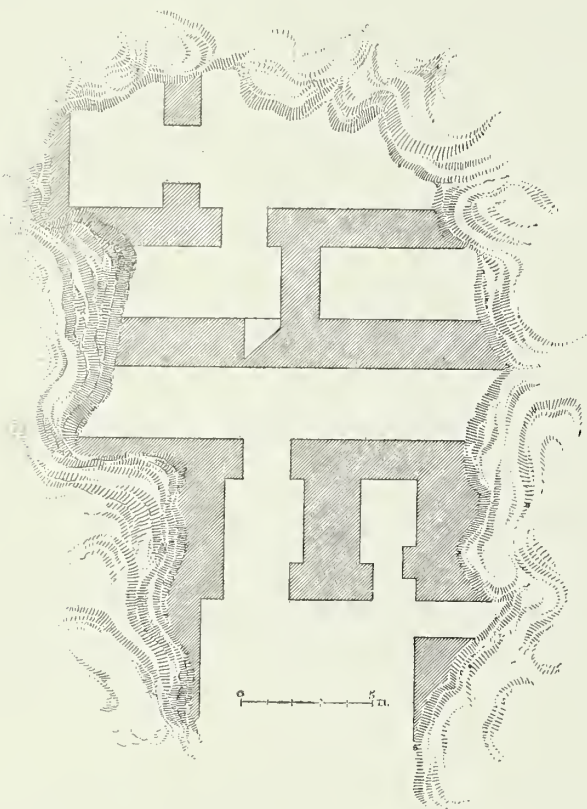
PLANTA DE ALGUNAS CÁMARAS DE UN PALACIO DESCUBIERTO EN MUGHEIR (SEGÚN TAYLOR)
